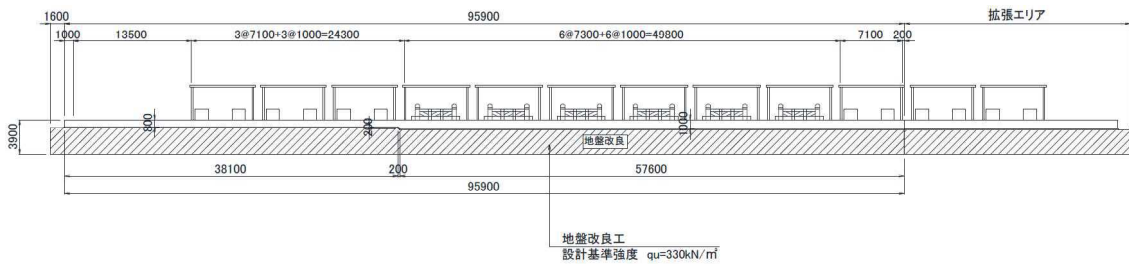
5 - 4 地盤改良断面図 (単位 : mm)
